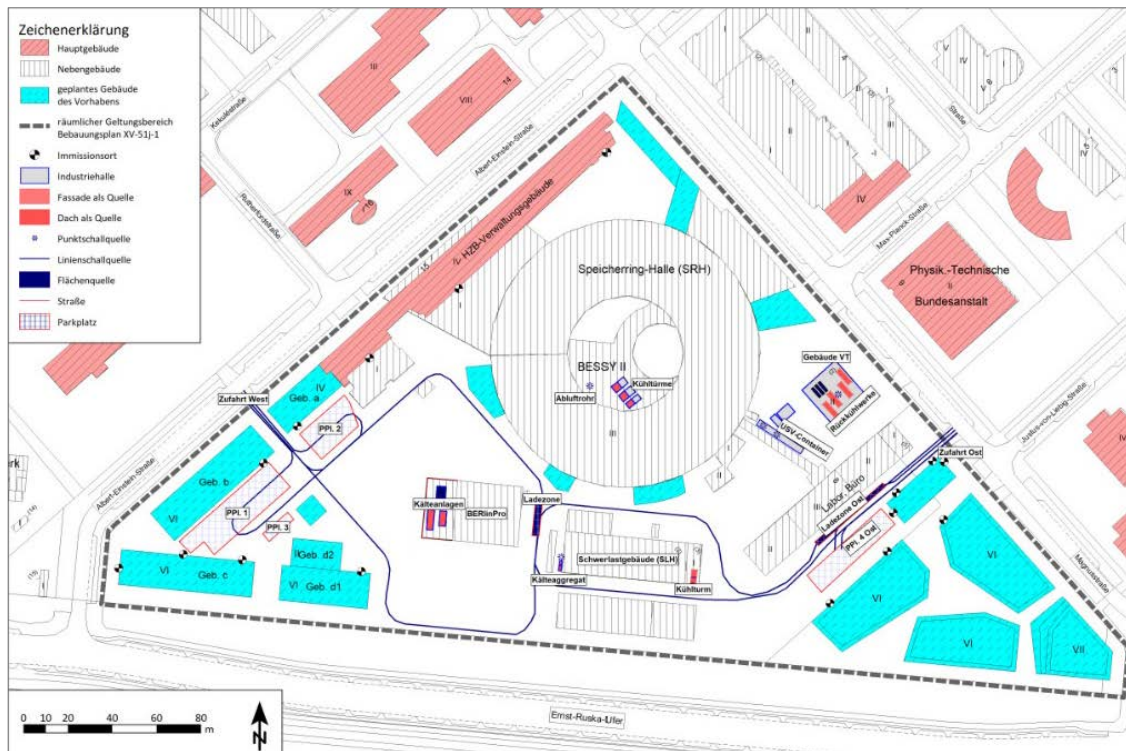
Lageplan der Immissionsorte für die Gewerbelärmuntersuchung innerhalb des Plangebiets mit geplanten Gebäuden gemäß Masterplan 2017 (ALB 2024, S. 26)
